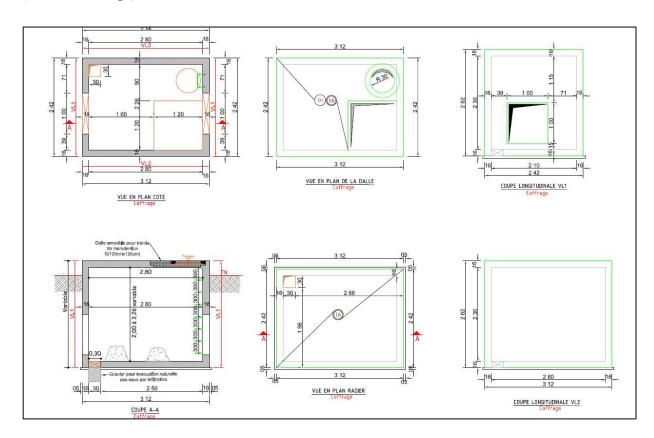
Exemple de plan d'exécution de regards de ventouse (Plan de coffrage)
